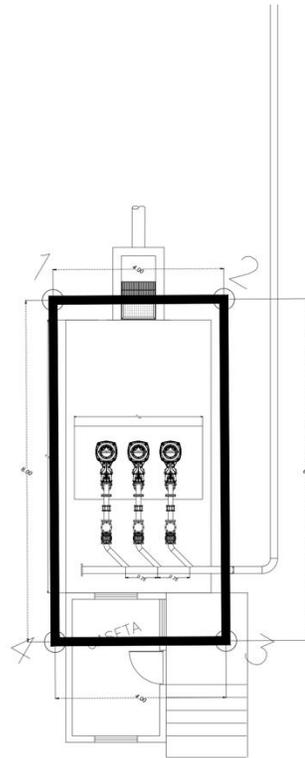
Conjunto de la Planta General y Tren de descarga de la "Construcción del Cárcamo de Bombeo".
